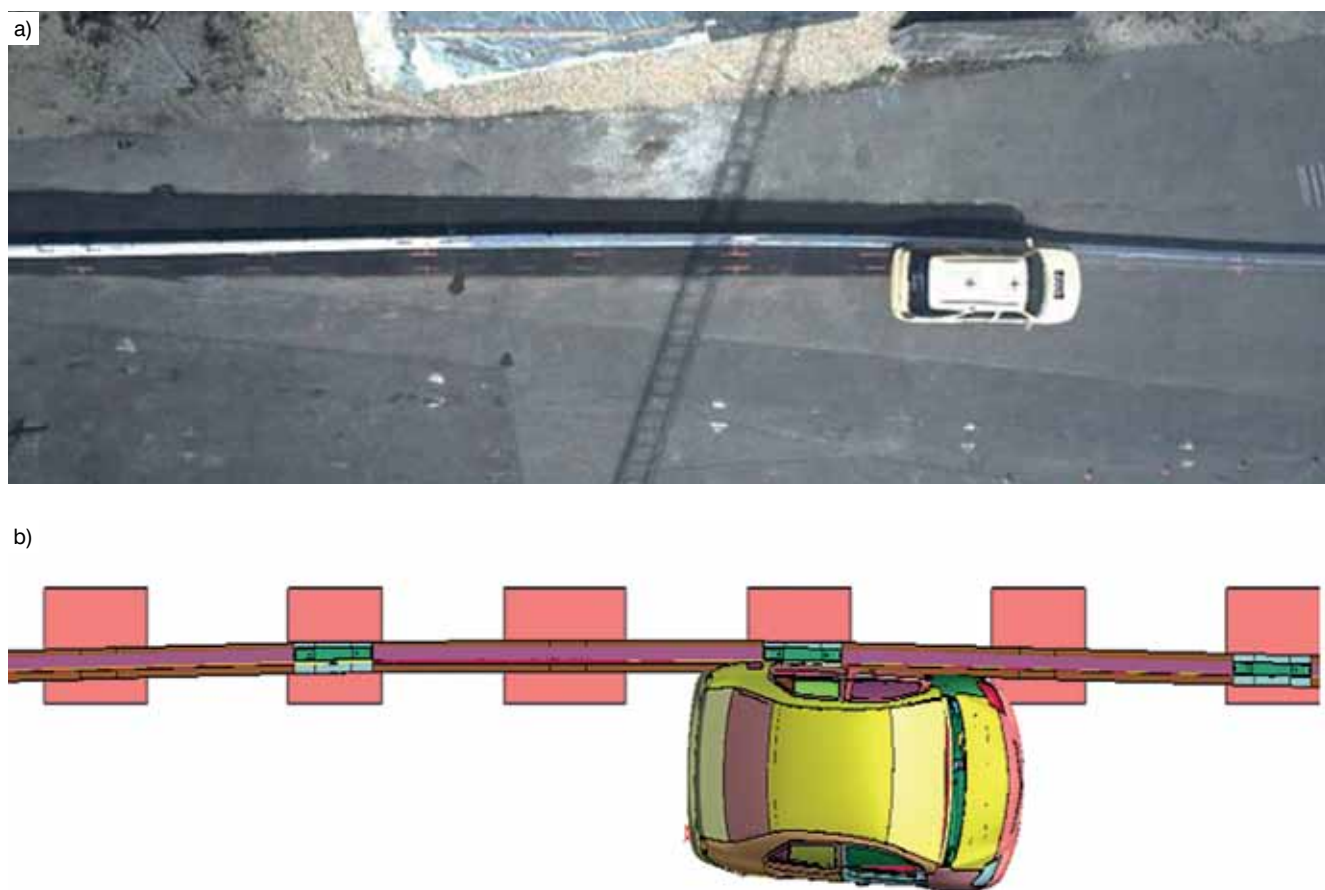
Testy zderzeniowe: a) bariera przygotowana do testów, b) bariera po teście zderzeniowym
